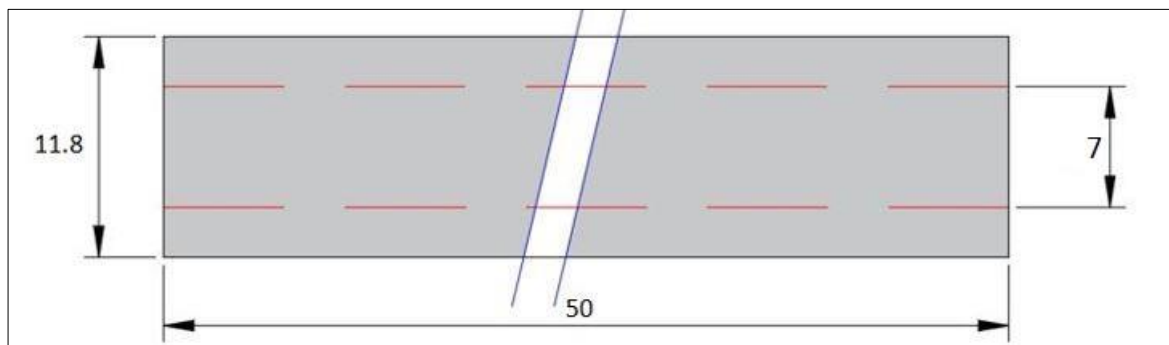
Vue en plan de la dalle de la Travée de rive
